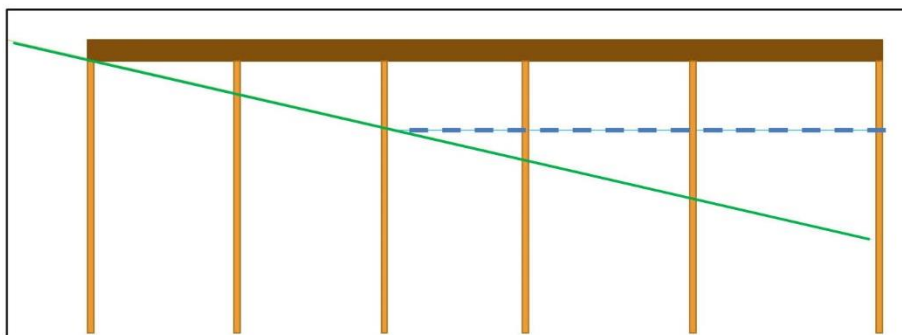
Planillustration (2023-04-13). Underlag från Liljewall.
